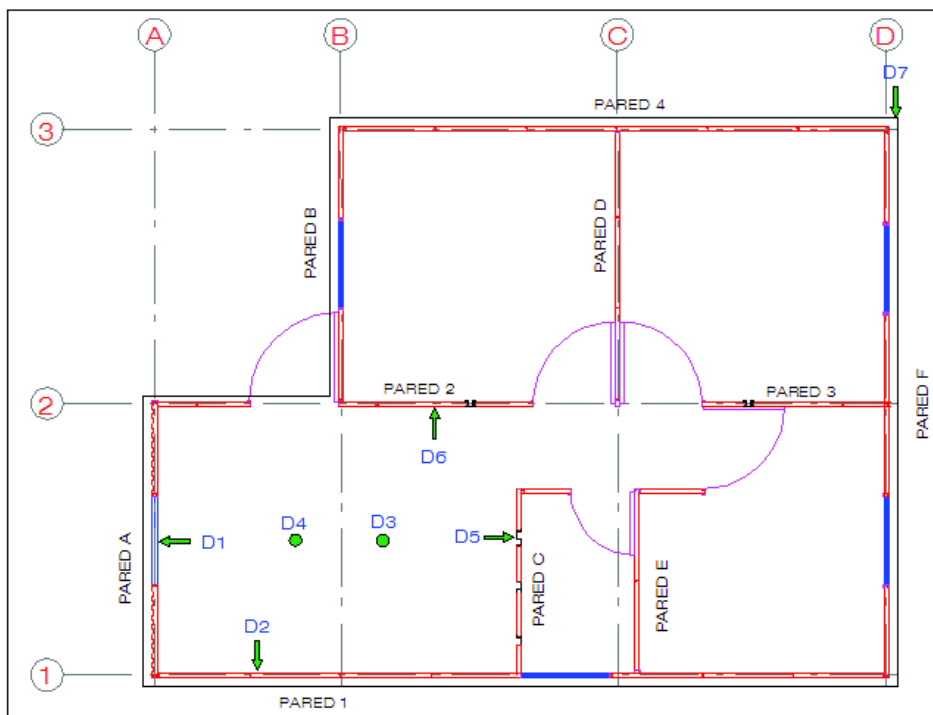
DEFORMÍMETROS UTILIZADOS EN PRUEBA DE CARGA
